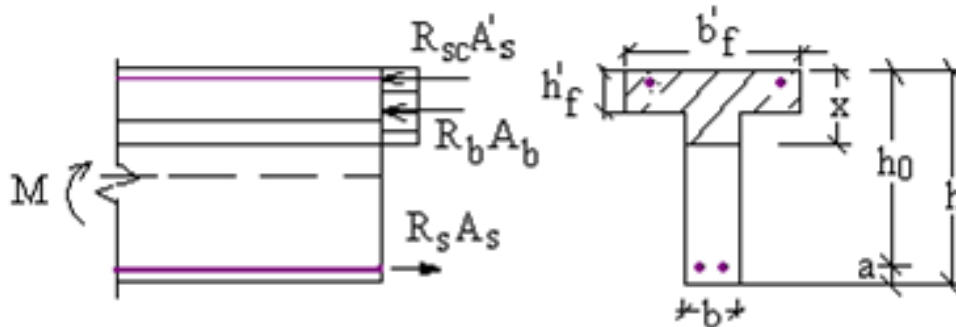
Розрахункова схема таврового перерізу з подвійним армуванням
